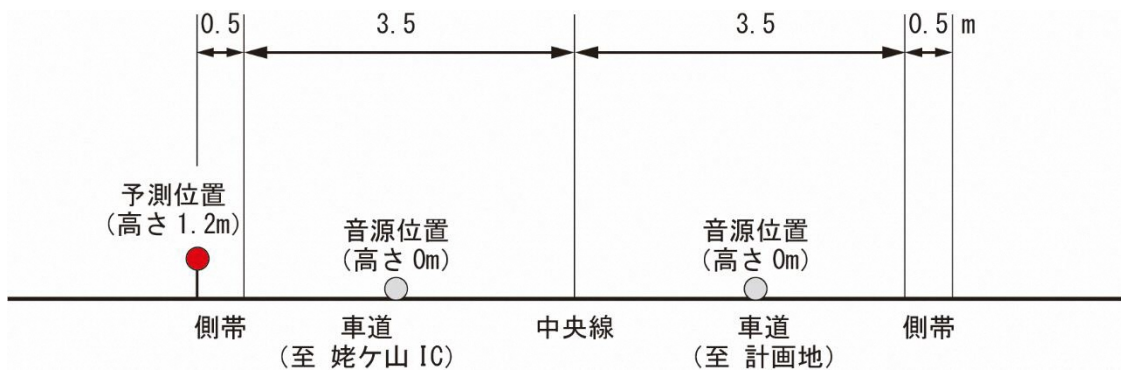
(2) 道路断面図 (No.2 : 嘉瀬蔵岡線沿道 (西側))
